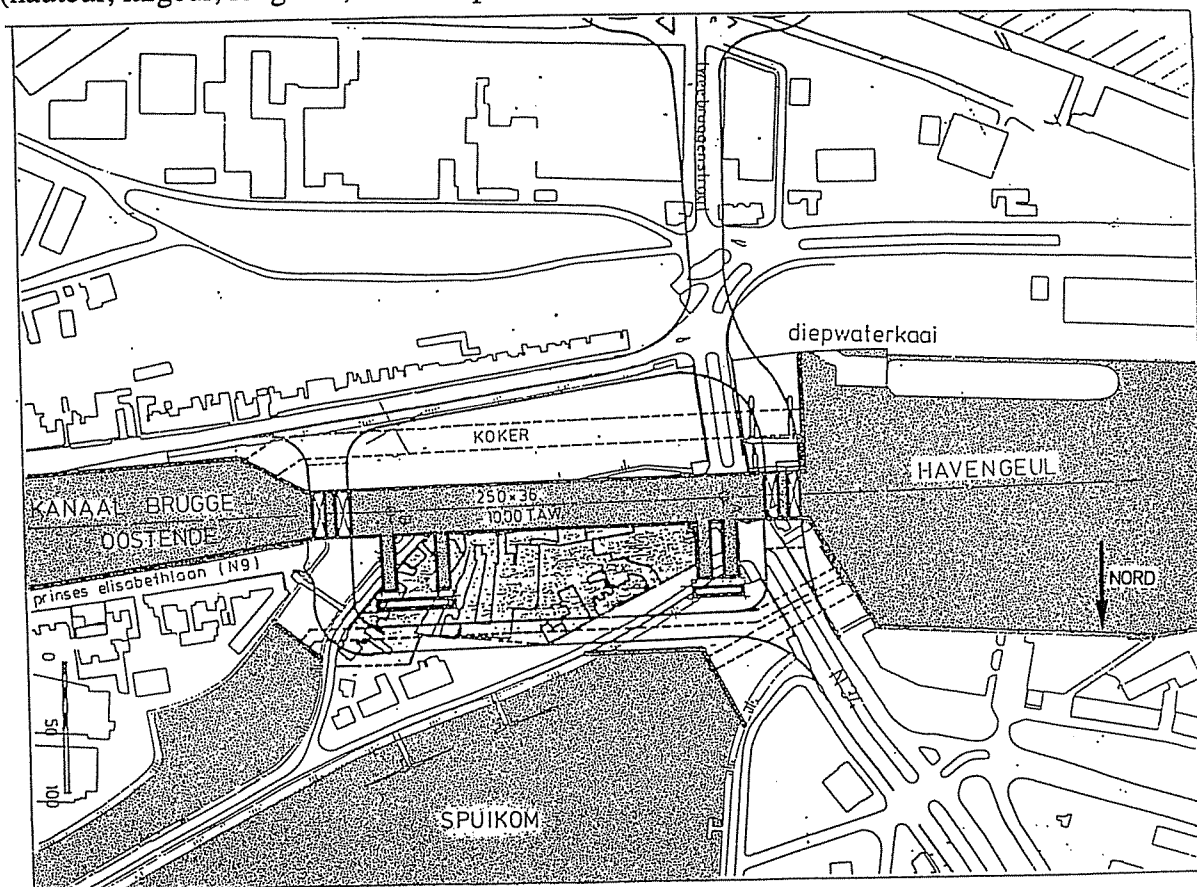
b : Plan d'implantation de l'écluse de 250 x 36 m
